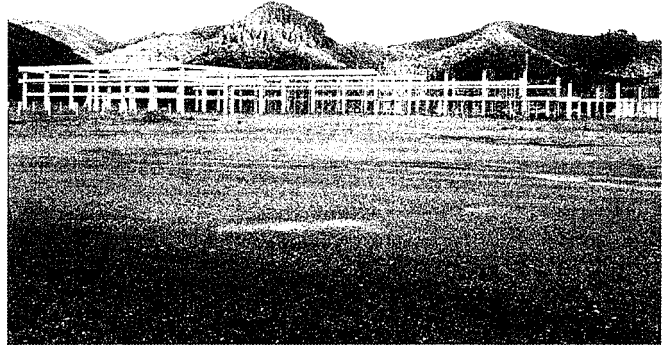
Cimento Nassau: construção de unidade industrial paralisada.
